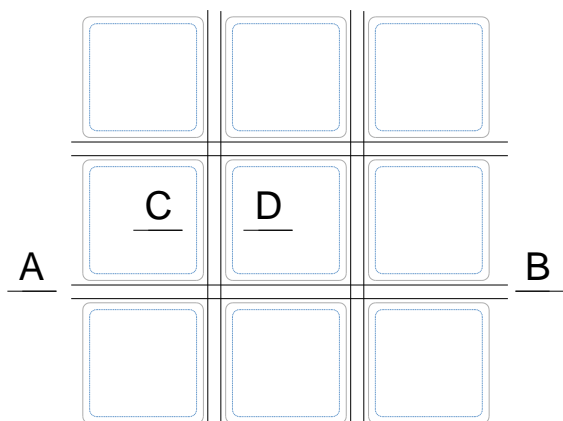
Laje aligeirada com as armaduras inferiores tipo apresentadas a preto.
